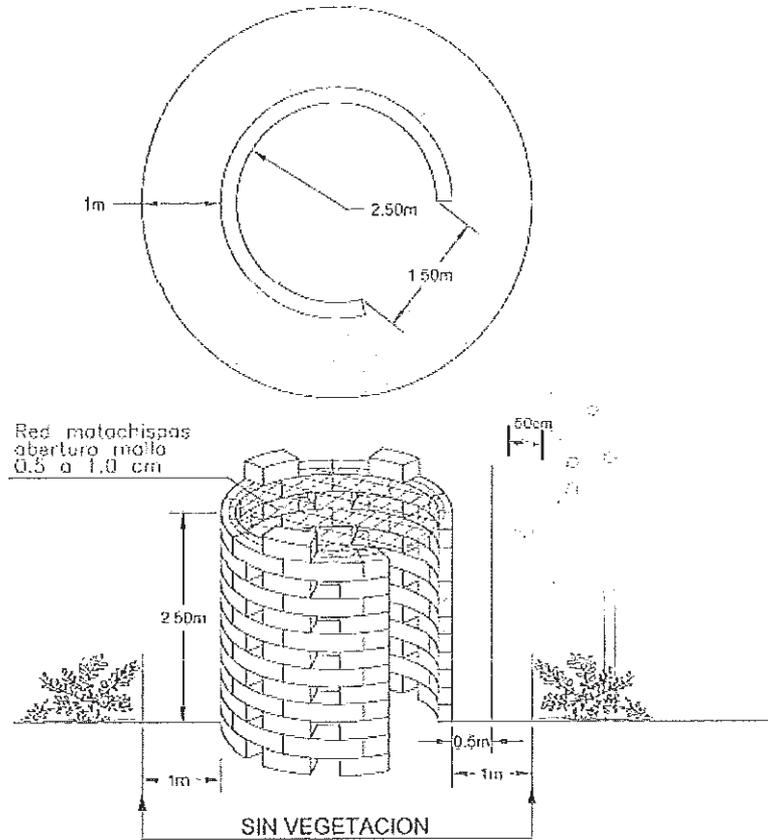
Plana y alzado de un quemador: debidamente acondicionado.
